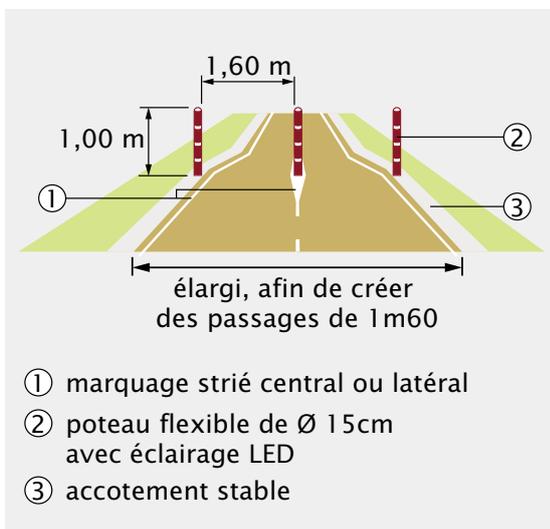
Les poteaux doivent être précédés d'un marquage strié.
